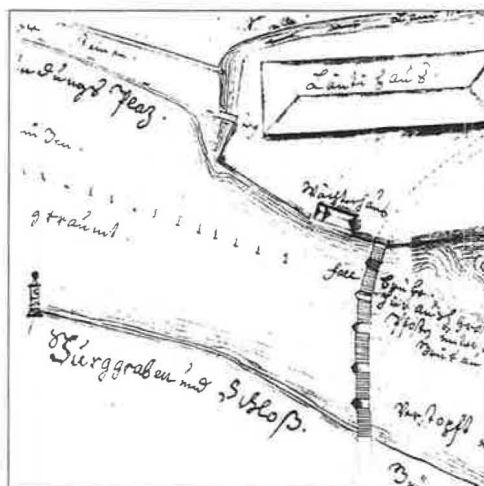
Ausschnitt aus dem «Plan über die Ableitung der Madretsch-Schuss zu Nidau», 1781, von Abraham Pagan (Projekt wurde nie ausgeführt). Im Planausschnitt sind die fünf steinernen Brückenpfeiler mit Vormauerung oberstrom gut sichtbar. Der aufziehbare Brückenteil ist zwischen dem vierten und fünften Pfeiler mit Fallbrücke bezeichnet (STAB AA, V, Zihl Nr. 7).
